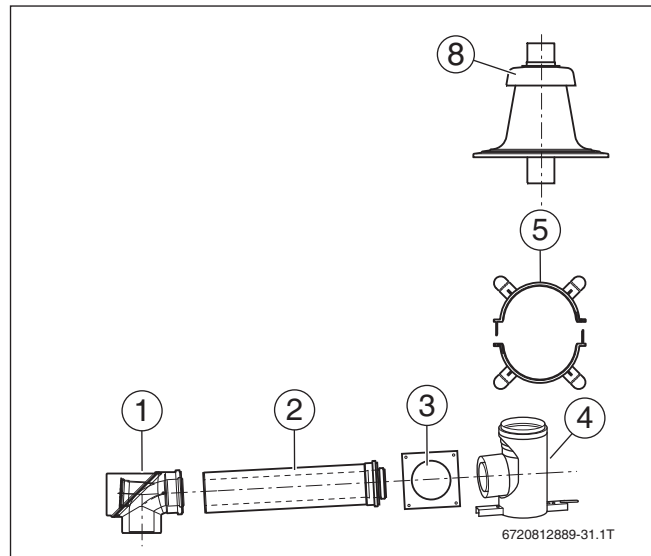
Bauteile Grundbausatz DO-S in DN 110/160
